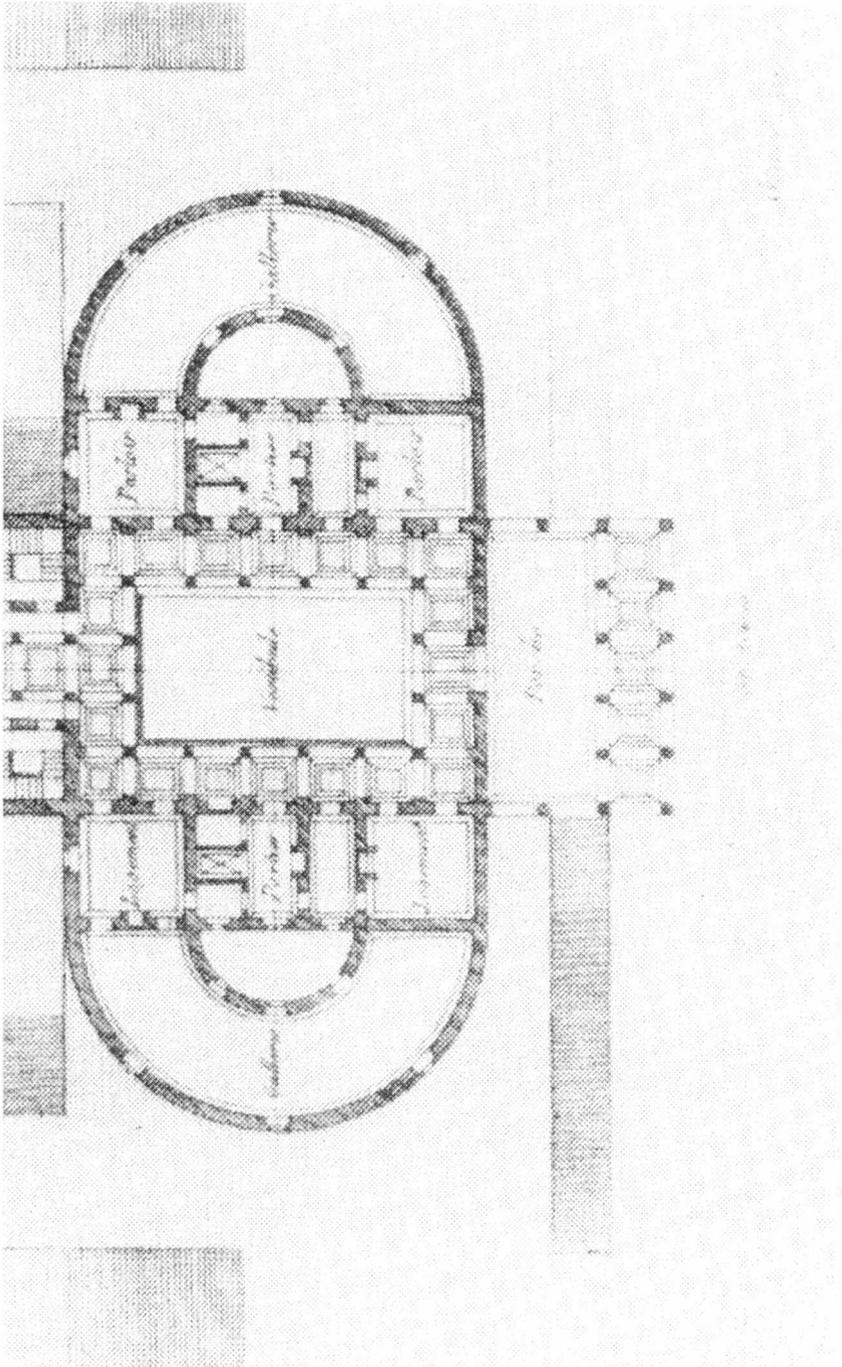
Un sector de la planta de la "Casa del Placer" de Claude Ledoux.
